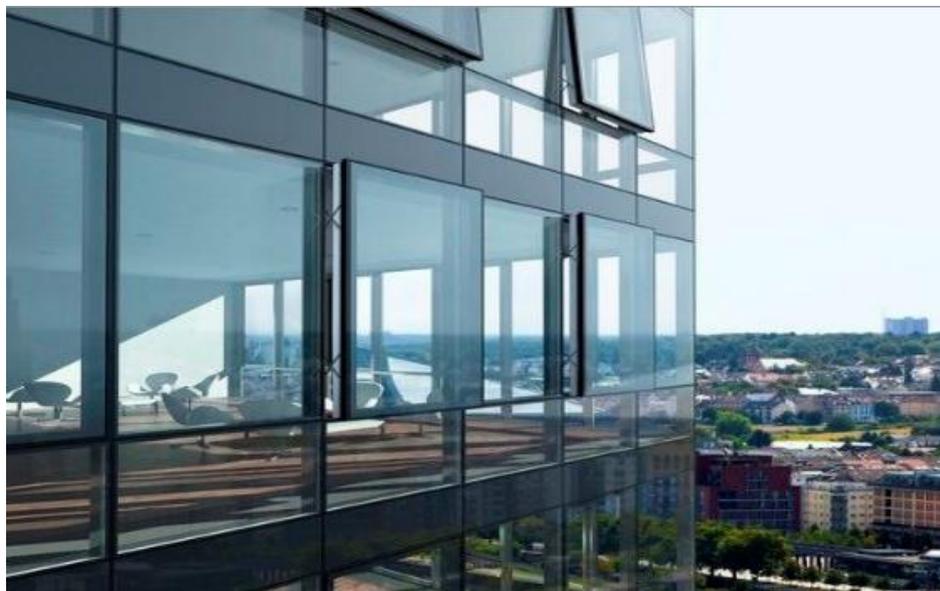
Muros cortina montados sobre bastidores prefabricados. (Fran Bretones,2014:15).
